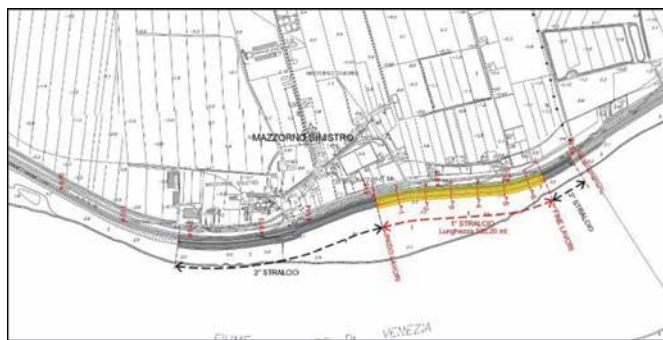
Planimetria con evidenza (in colore giallo) il tratto di diaframma in progetto (I stralcio) - estesa di 505,20 m.
